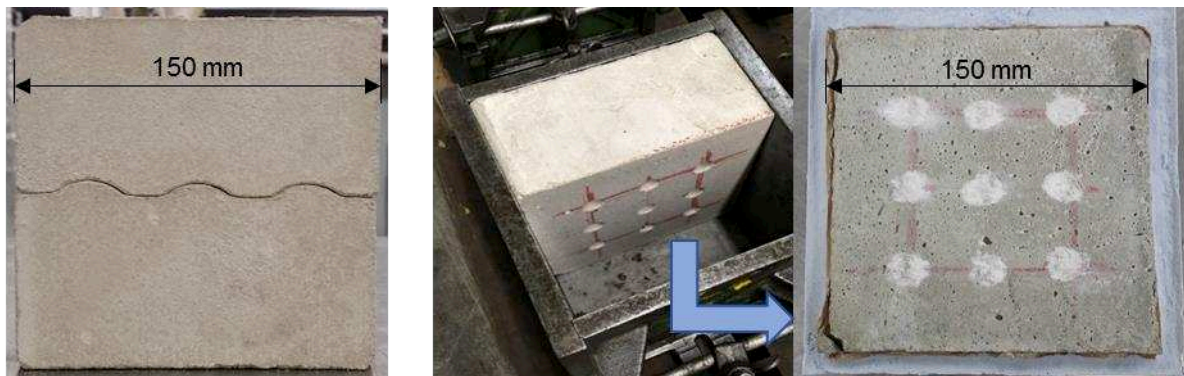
Proben mit Betonierfuge mit Wellen- (links) und mit Noppenprofil (rechts)
